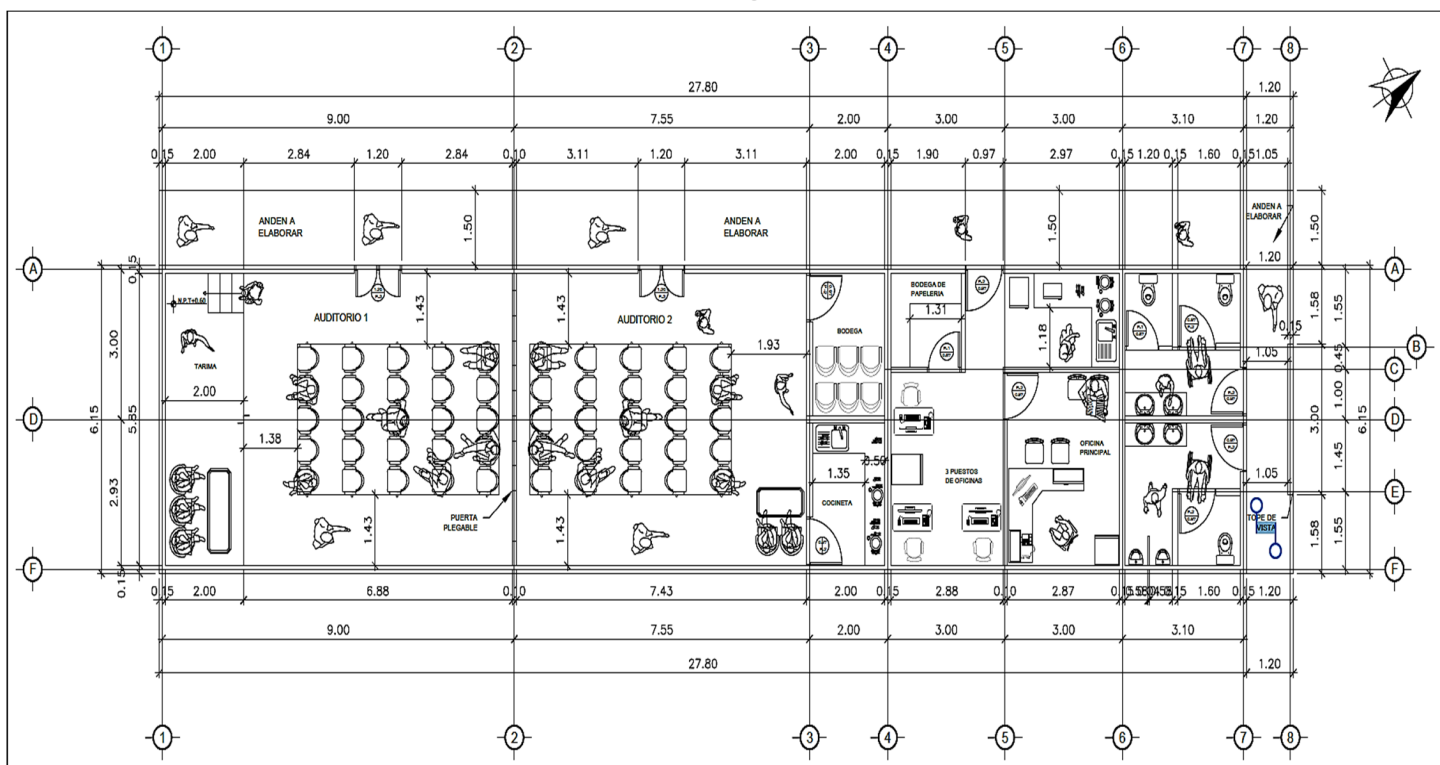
Planta Arquitectónica del Centro de Convenciones SILAIS-Managua/Fuente: Elaboración propia.
